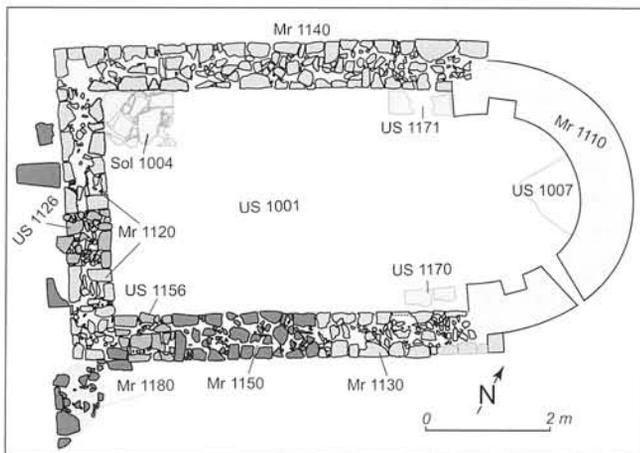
PIERLAS, chapelle Saint-Sylvestre.
